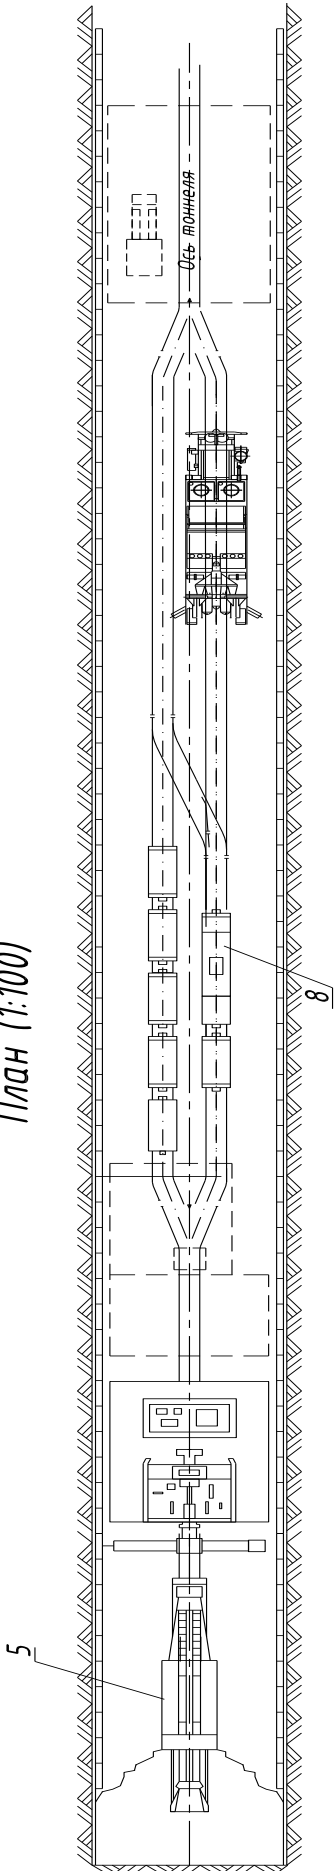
Обладнання для проходки переднього тунелю (на плані): 5 - розчинонагнітач С-334; 8 - електровоз К-10
